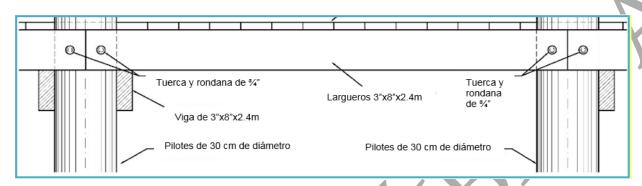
Detalle longitudinal de la estructura de conexión.
